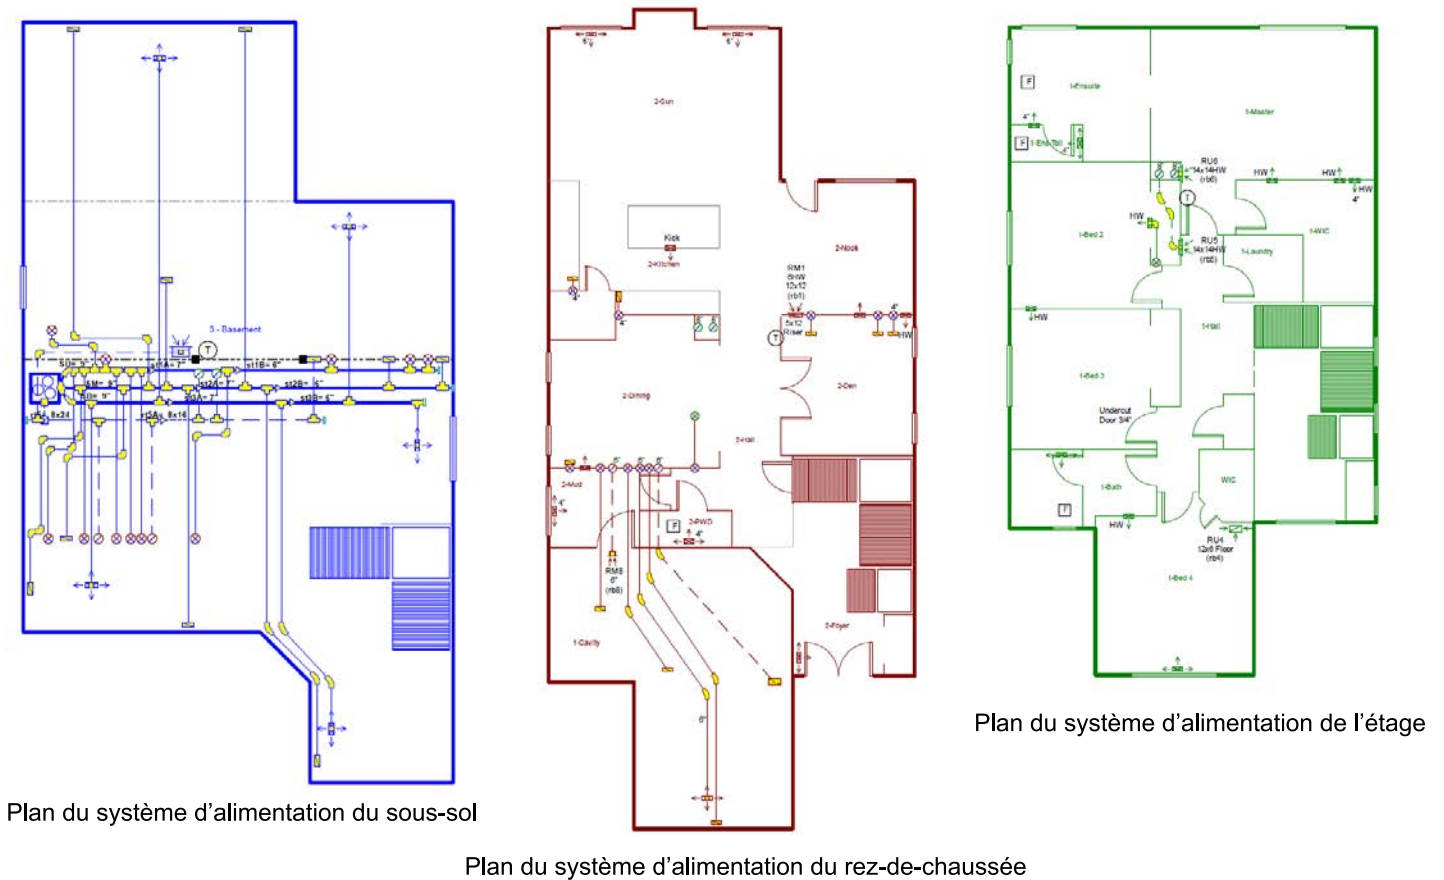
Plan des conduits d'alimentation de l'exemple de concept des conduits par zone
